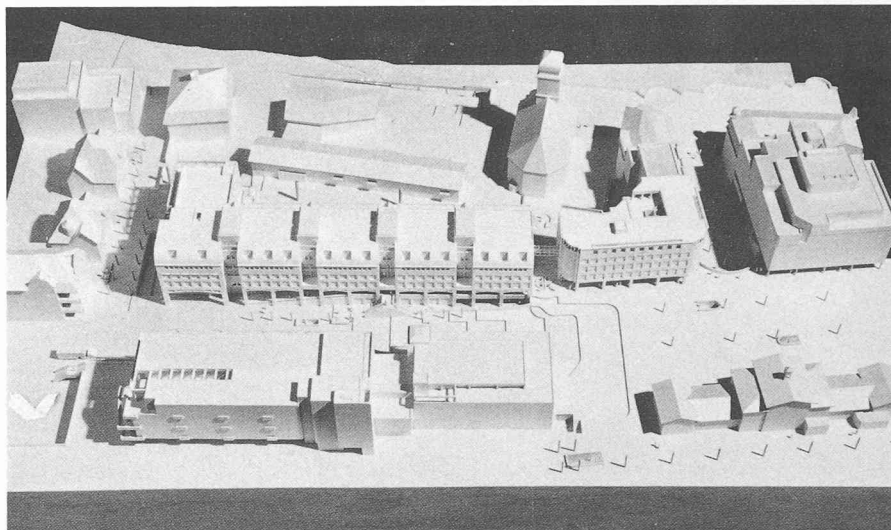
Place et rue de la Gare. Maquette vue de l'ouest; façade donnant sur la nouvelle poste.
